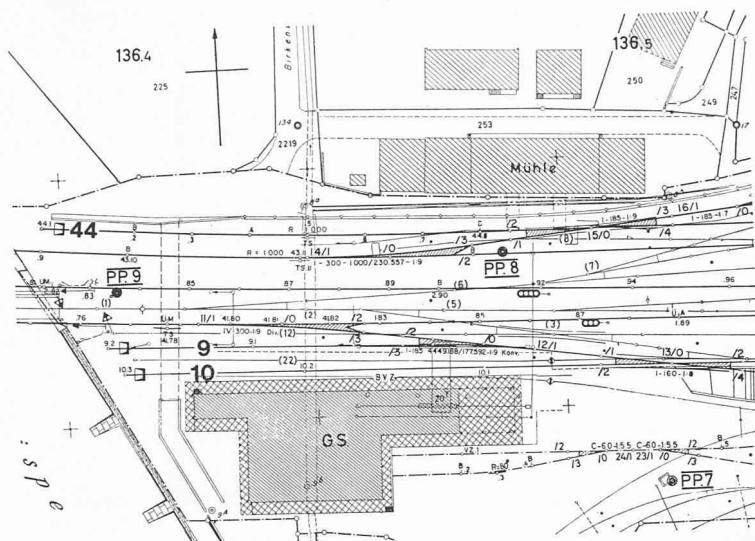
Extrait du plan de situation de la gare de Viège.
